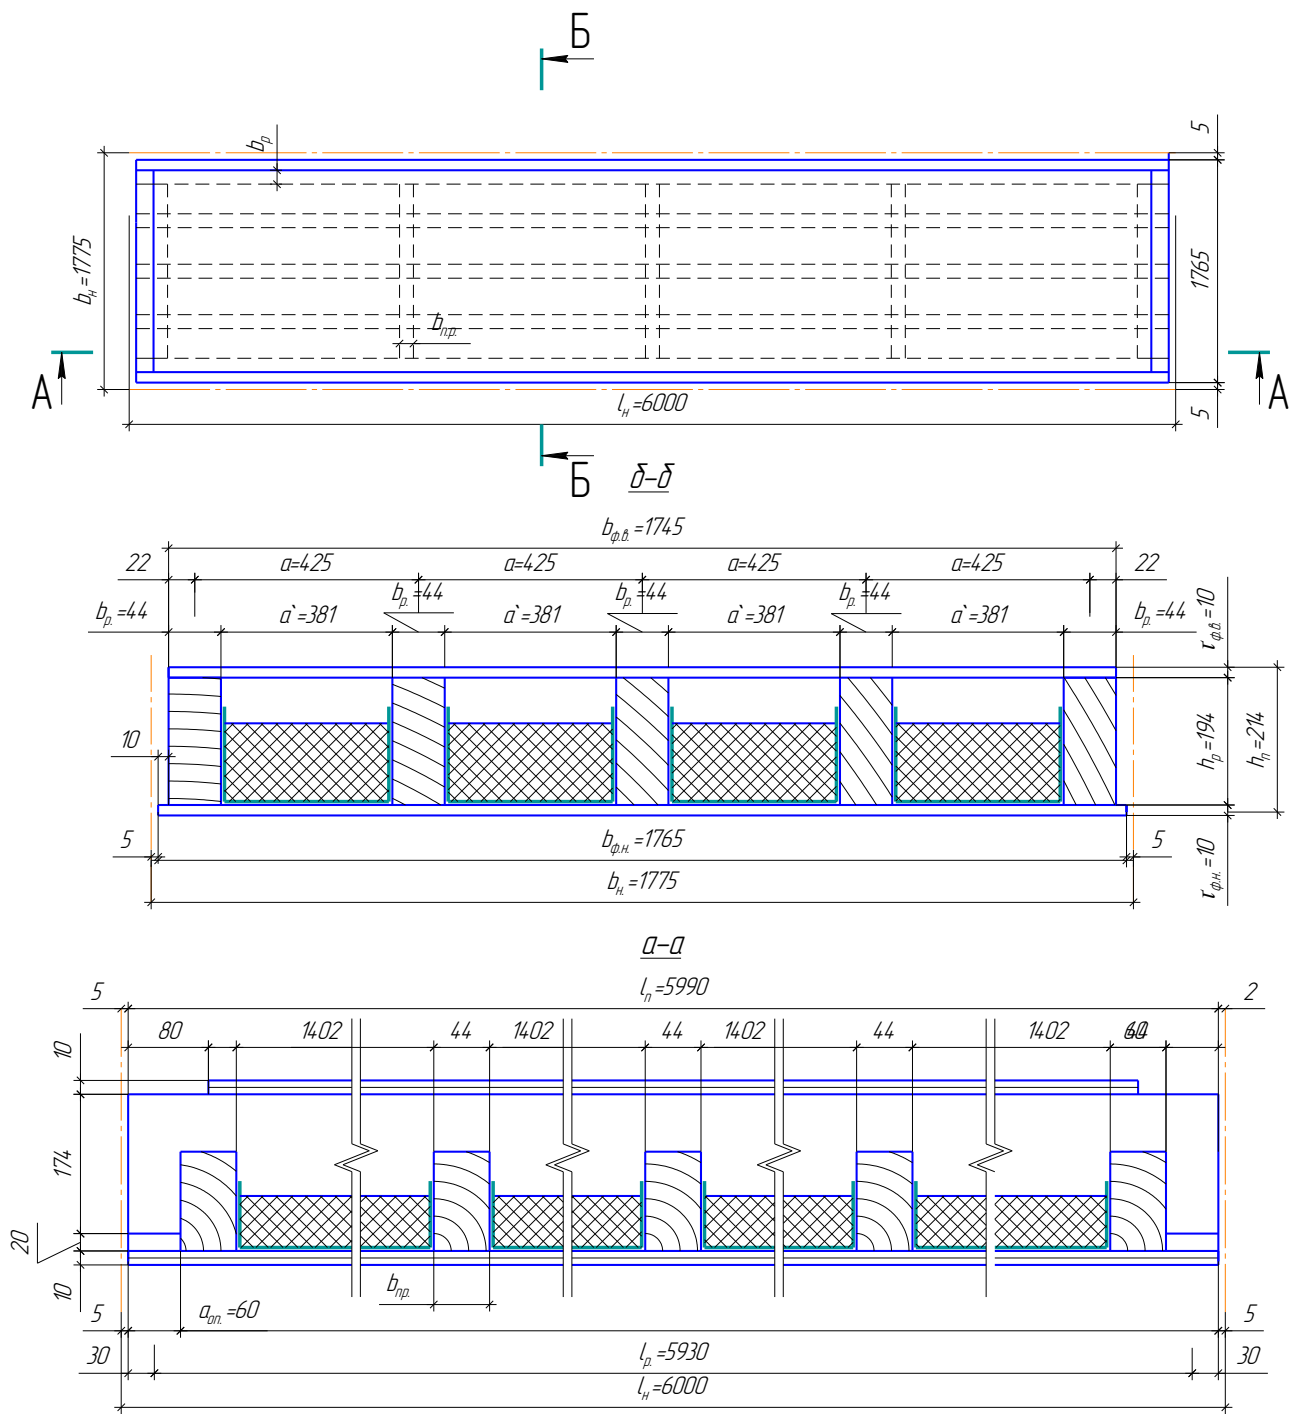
Утепленная плита покрытия с фанерными обшивками
